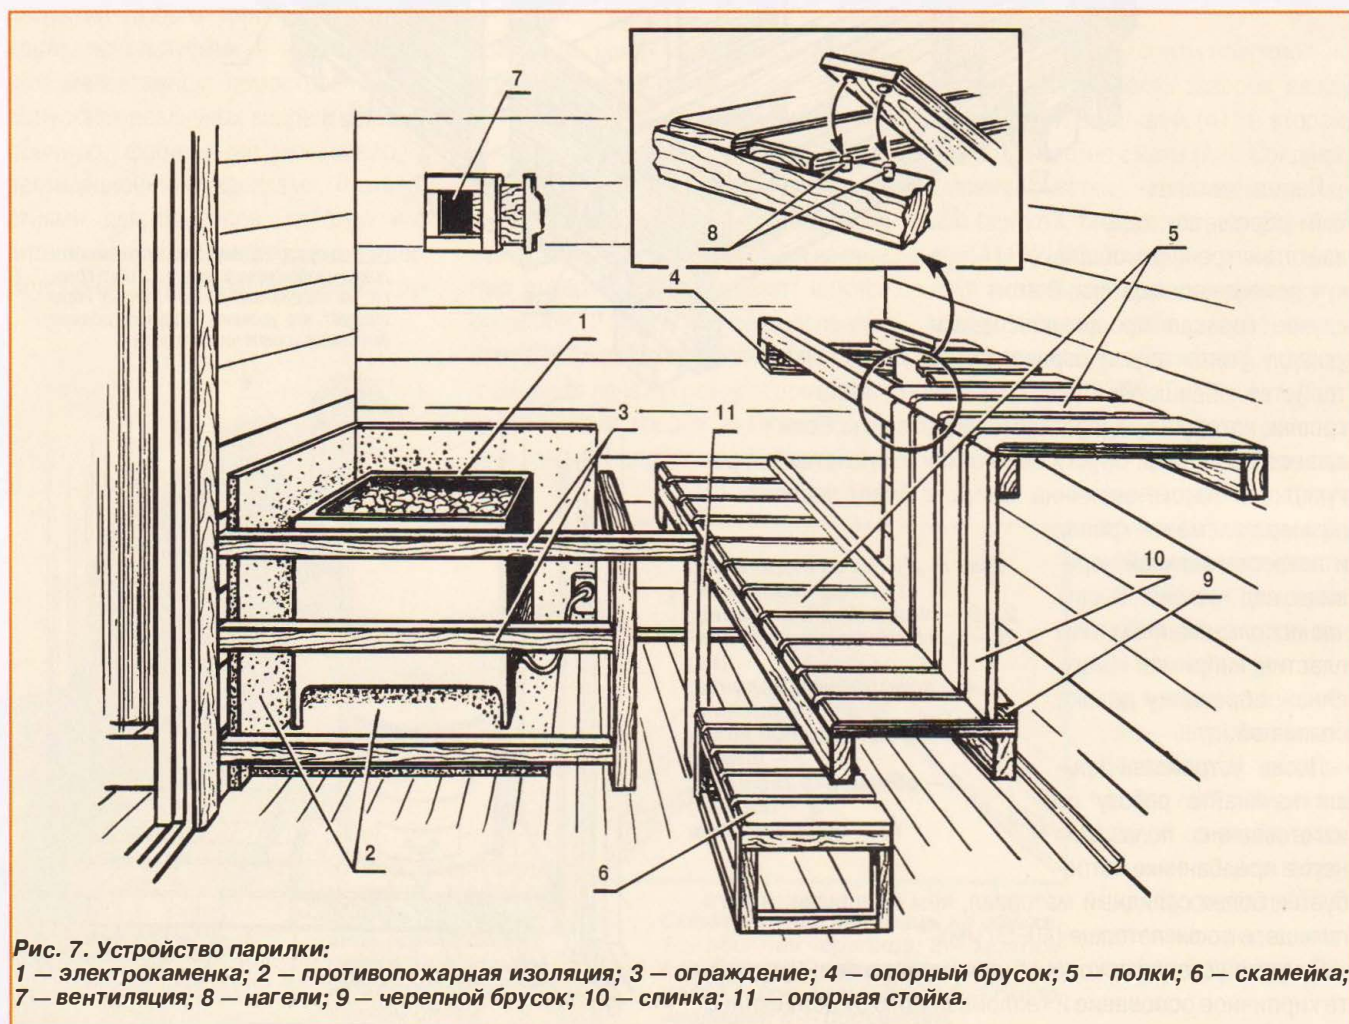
Устройство парилки: 1 — электрокаменка; 2 — противопожарная изоляция; 3 — ограждение; 4 — опорный брусок; 5 — полки; 6 — скамейка; 7 — вентиляция; 8 — нагели; 9 — черепной брусок; 10 — спинка; 11 — опорная стойка.
